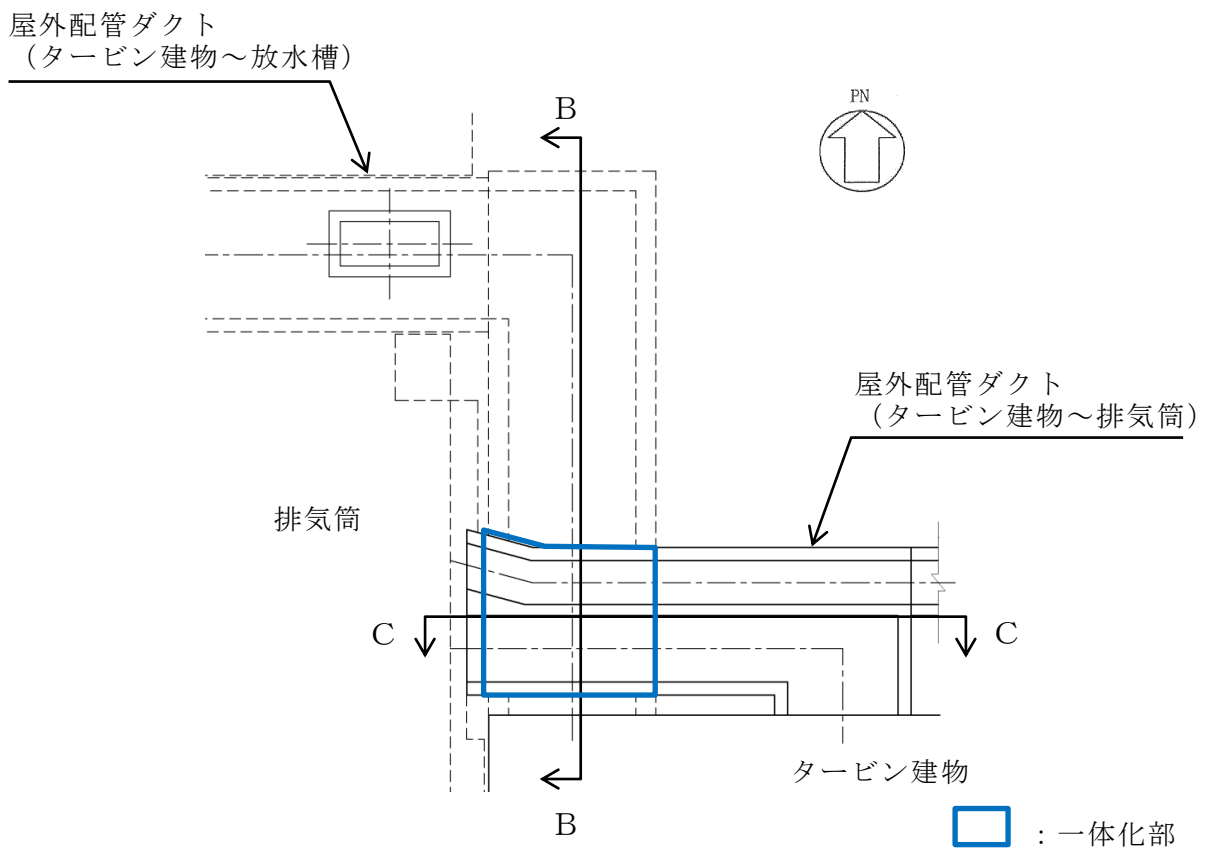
屋外配管ダクト（タービン建物～排気筒） 平面図
